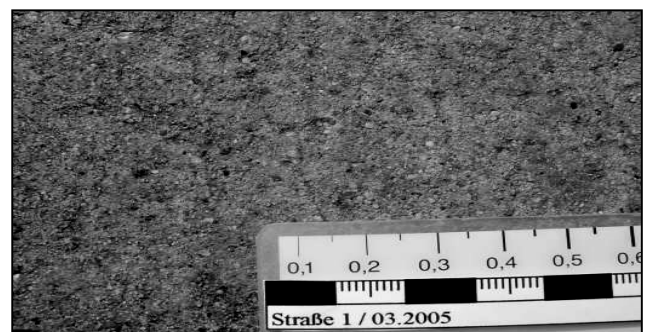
Straßenbeton 1: Oberflächenriss mit Rissweite von 0,15 mm nach 11 Jahren
